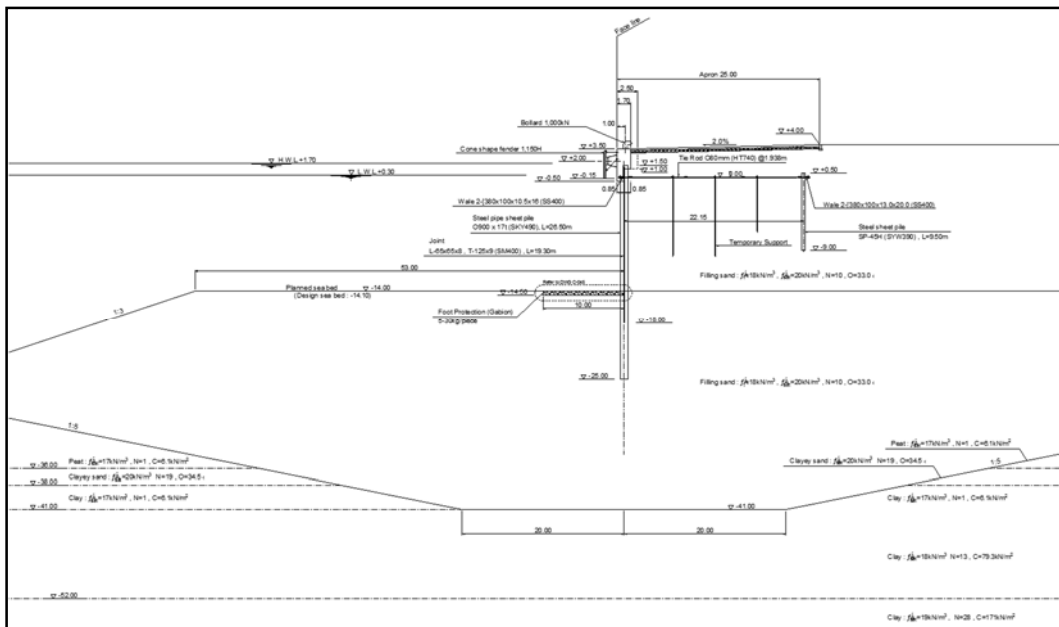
Profil type du nouveau quai ouest de -14 m (L=150 m)
